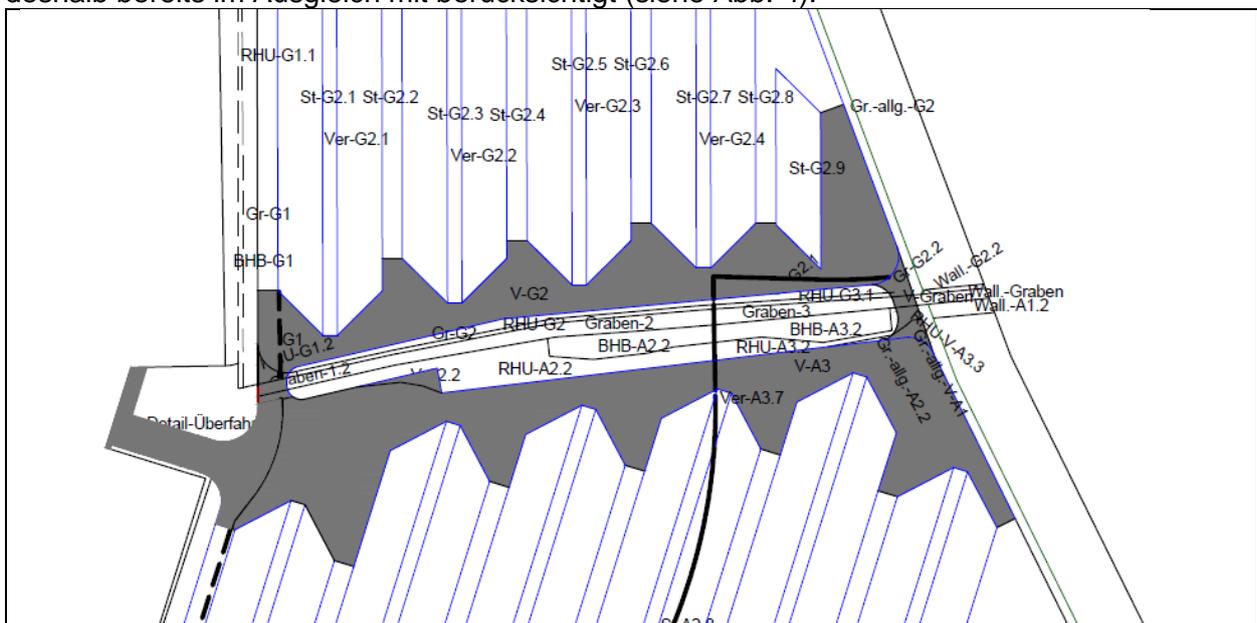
Vorsorglich bereits als vollversiegelt bilanzierte asphaltierte Flächen
